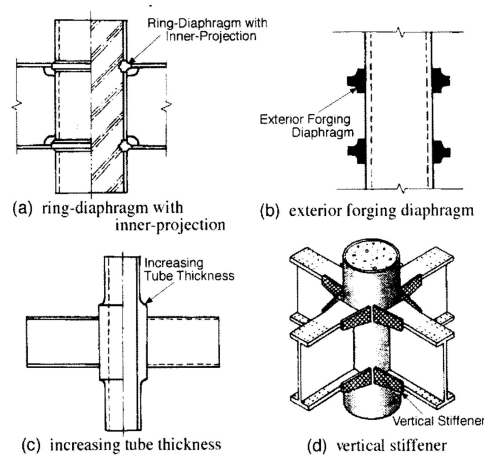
Sambungan konvensional antara balok baja dengan kolom CFT
